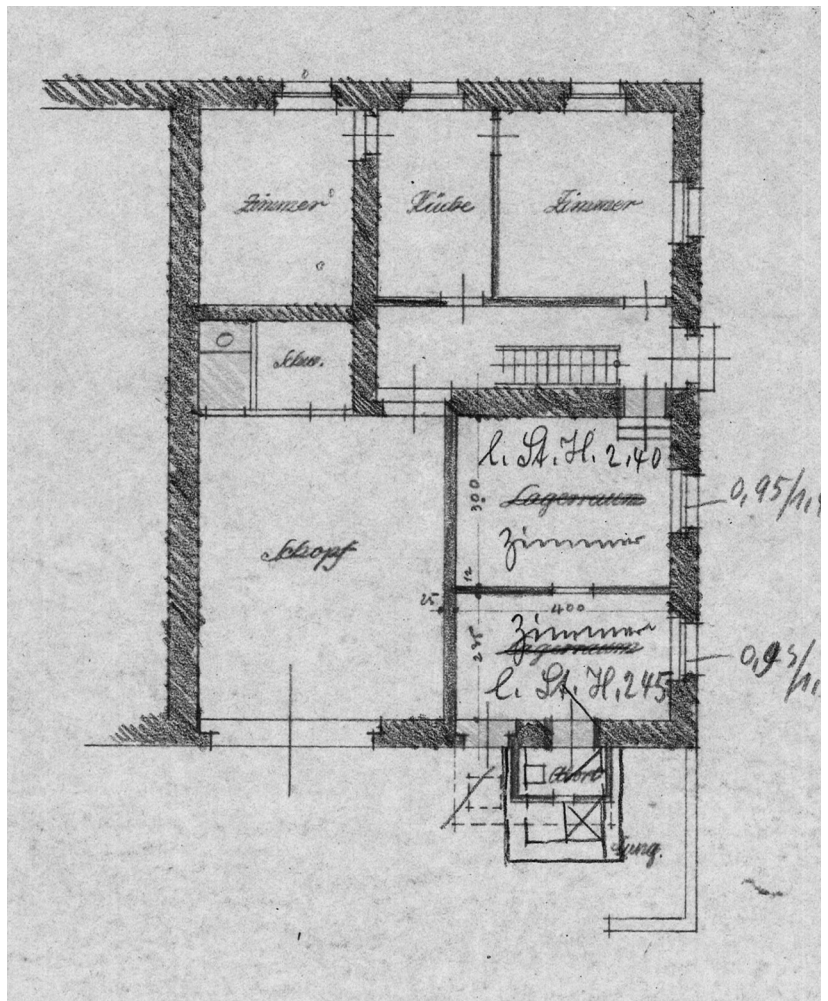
Jänergasse 8, Grundriss Erdgeschoss von 1929.
